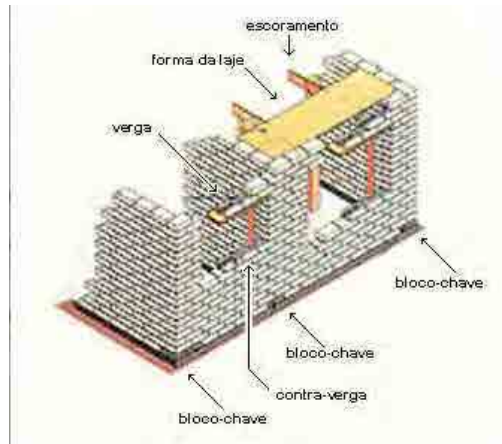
Esquema de elevação de alvenaria estrutural não armada
